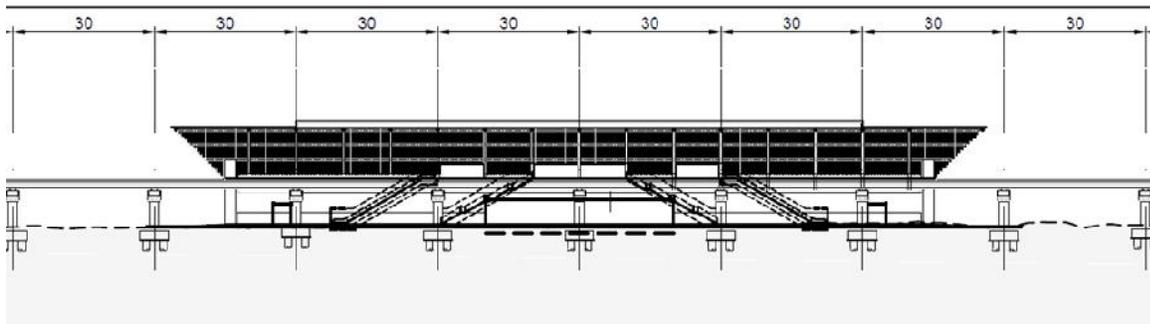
Perfil longitudinal del viaducto elevado en la zona de la Estación 11
